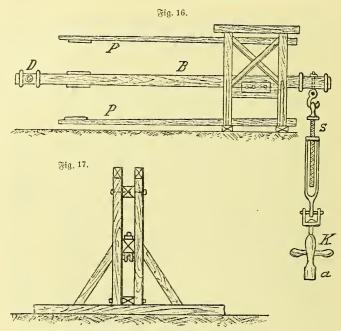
Bohrichwengel mit Ständer. - Fig. 17. Schwengelständer.
